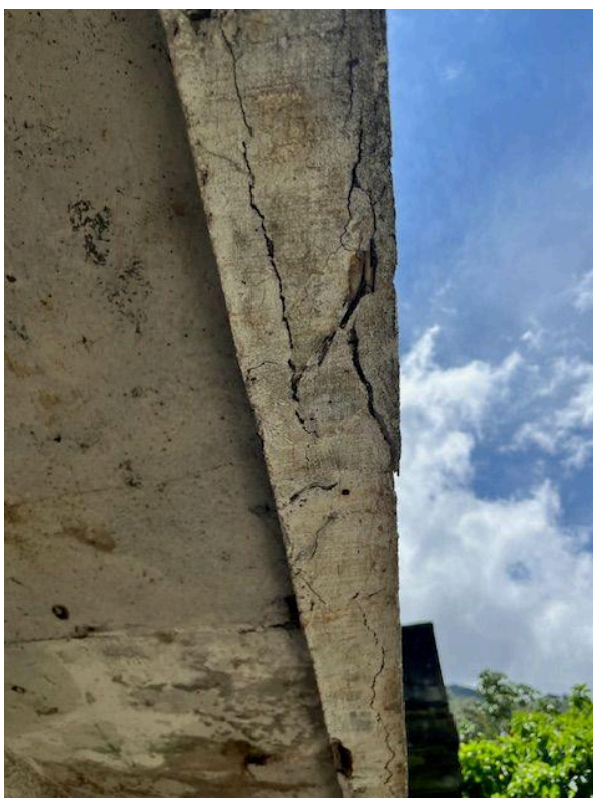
Marcação 3.3 - Corrosão de armaduras em lajes e vigas do subsolo.
